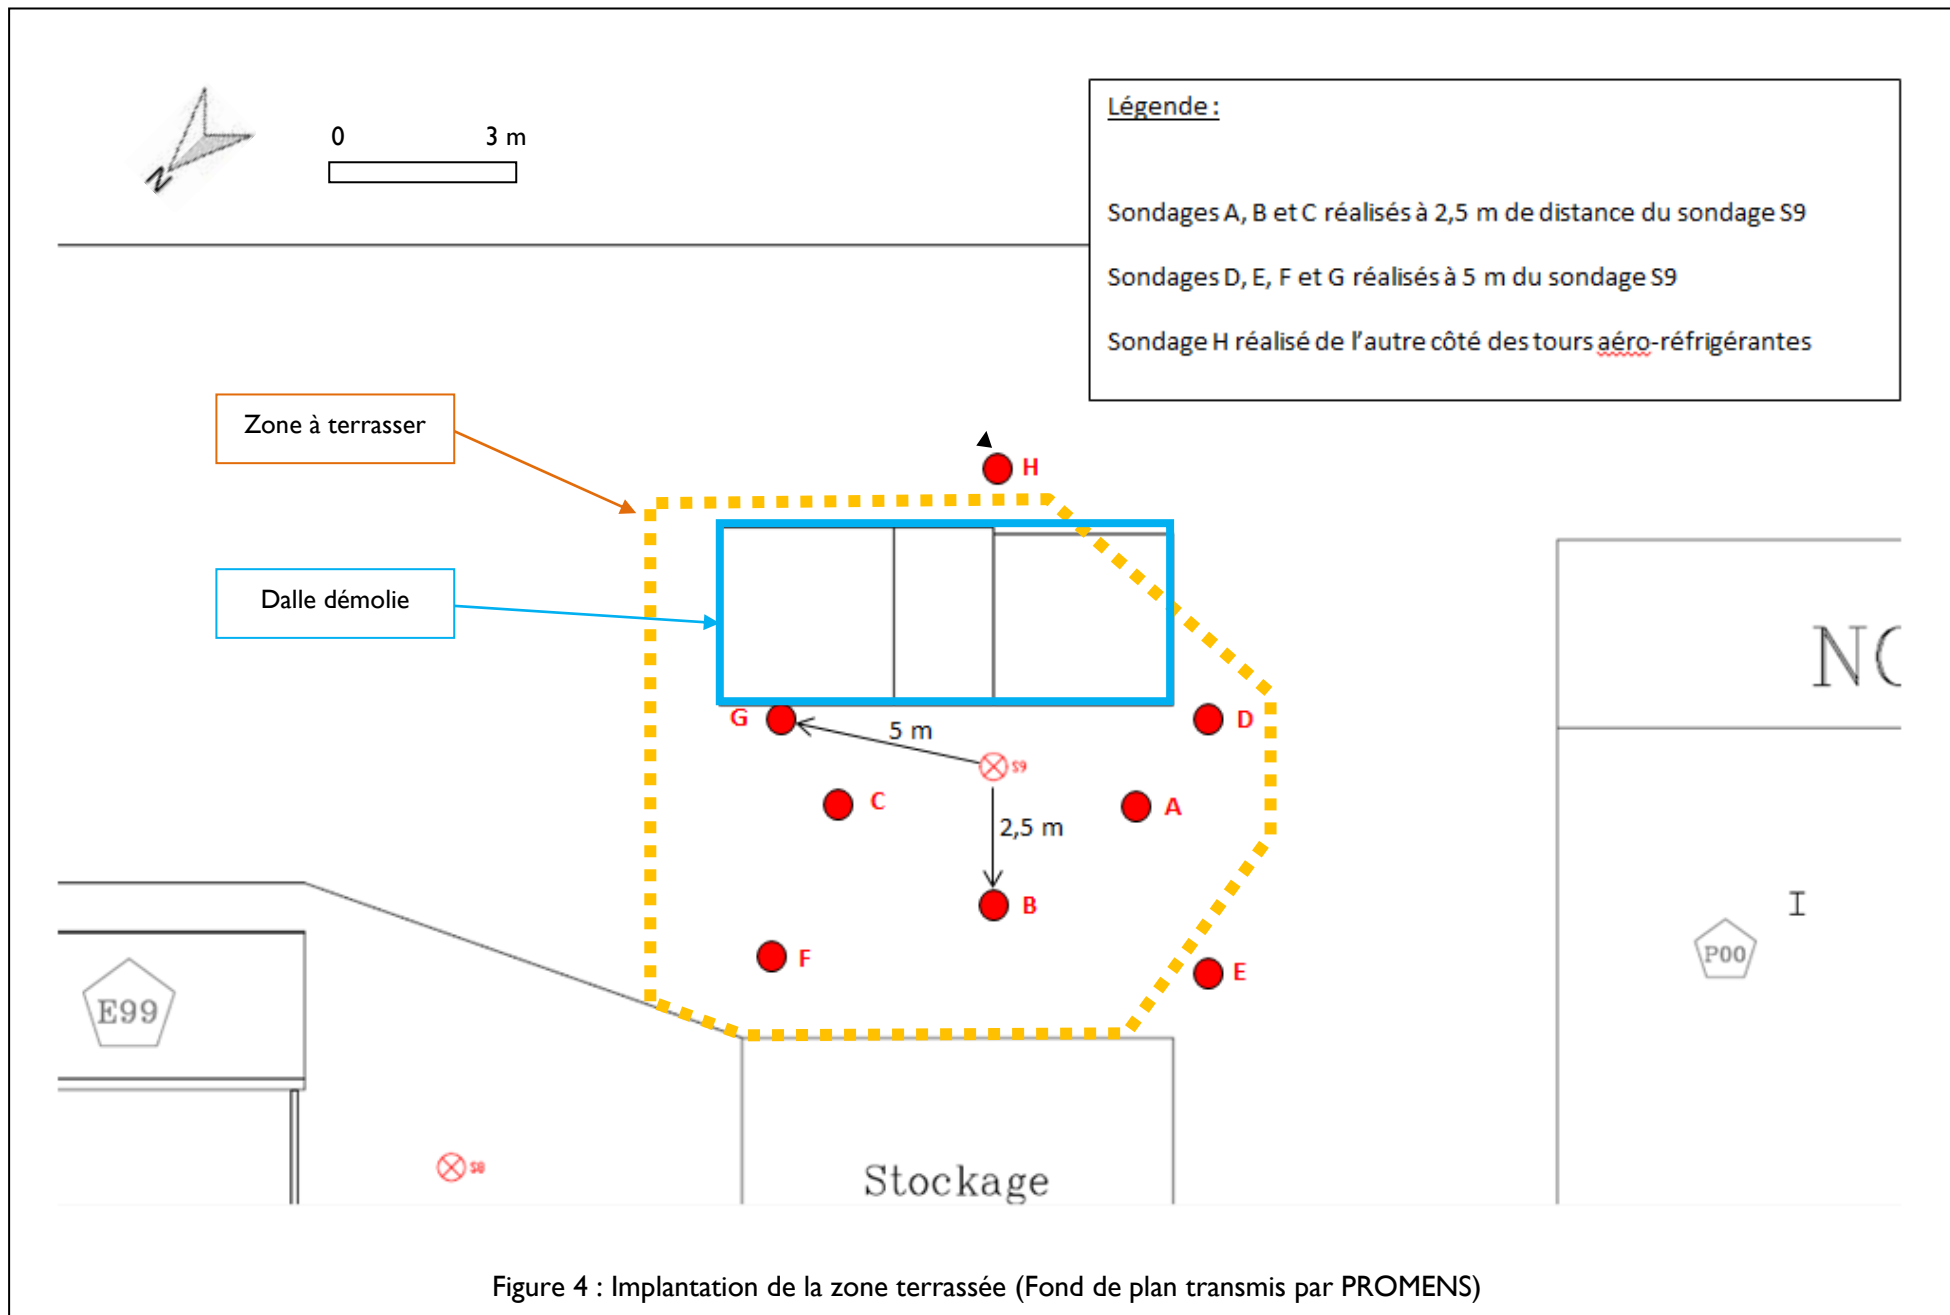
Implantation de la zone terrassée (Fond de plan transmis par PROMENS)
